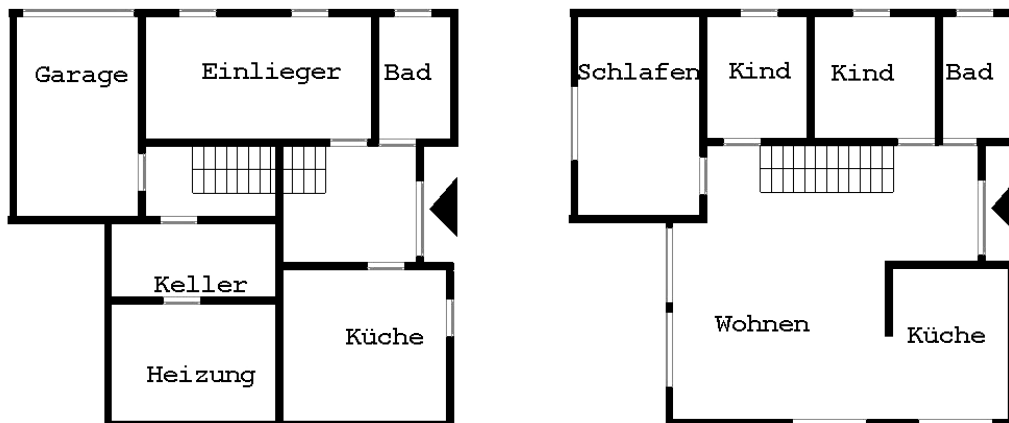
Grundrissbeispiel Zweifamilienhaus „individueller Typ“ mit großem Wohnraum, Einliegerwohnung und integrierter Garage, UG/EG, Baujahr 1970, Überzeichnungen im Internet veröffentlichter Immobilienangebote, ohne Maßstab
